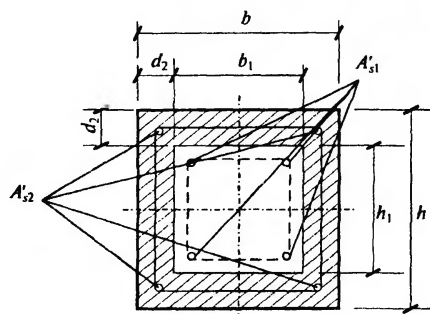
Поперечное сечение центрально сжатой колонны, усиливаемой железобетонной обоймой
